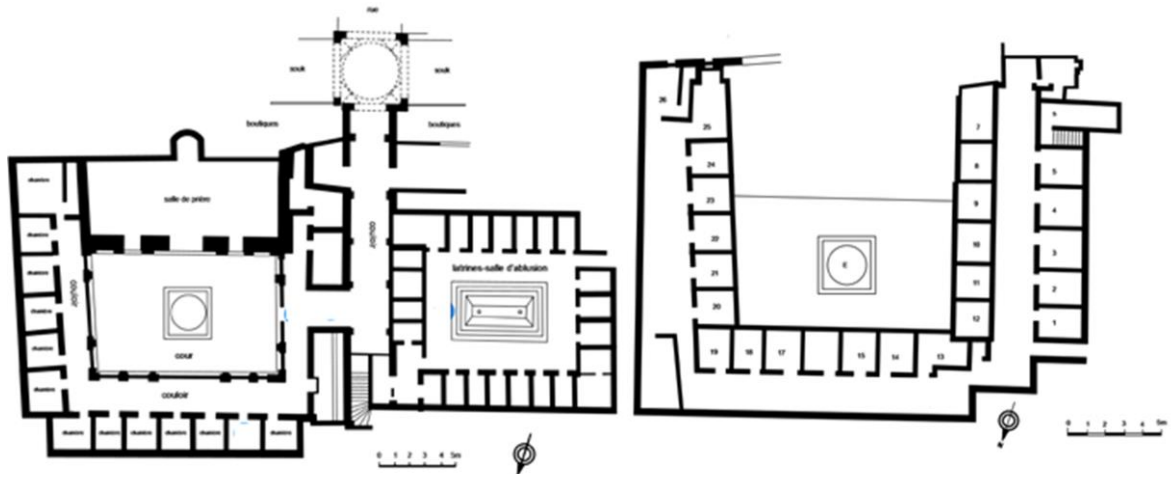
Vues en plan de rez-de-chaussée (en haut) et de l'étage (en bas) de la medersa el- Bou'nāniyya à Meknès
